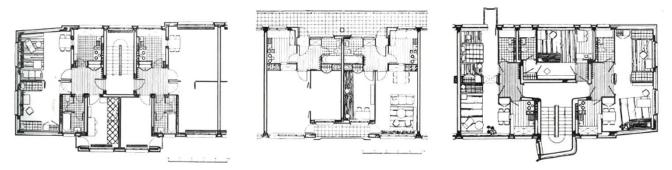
Planos de las viviendas situadas en la fachada sur. Recuperados de "L' architecture d'aujourd'hui, nº 87-88"
